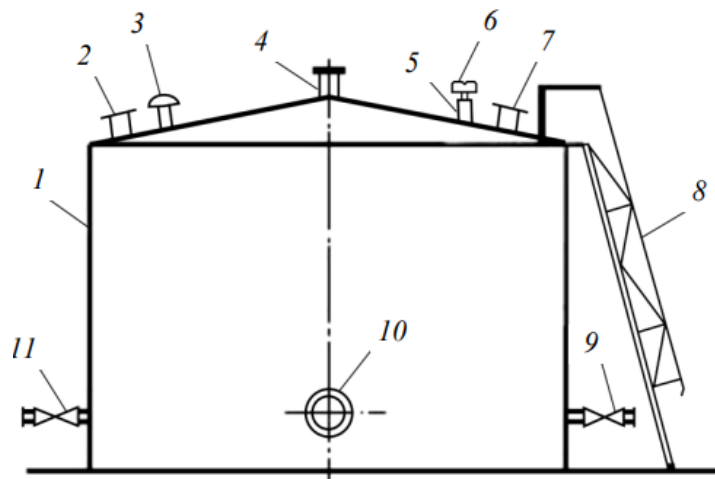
Схема улаштування вертикального сталевого резервуару:
